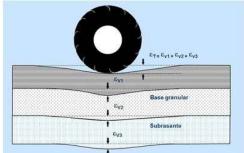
Deformation permanente en el pavimento nexible y en la capa subrasante
